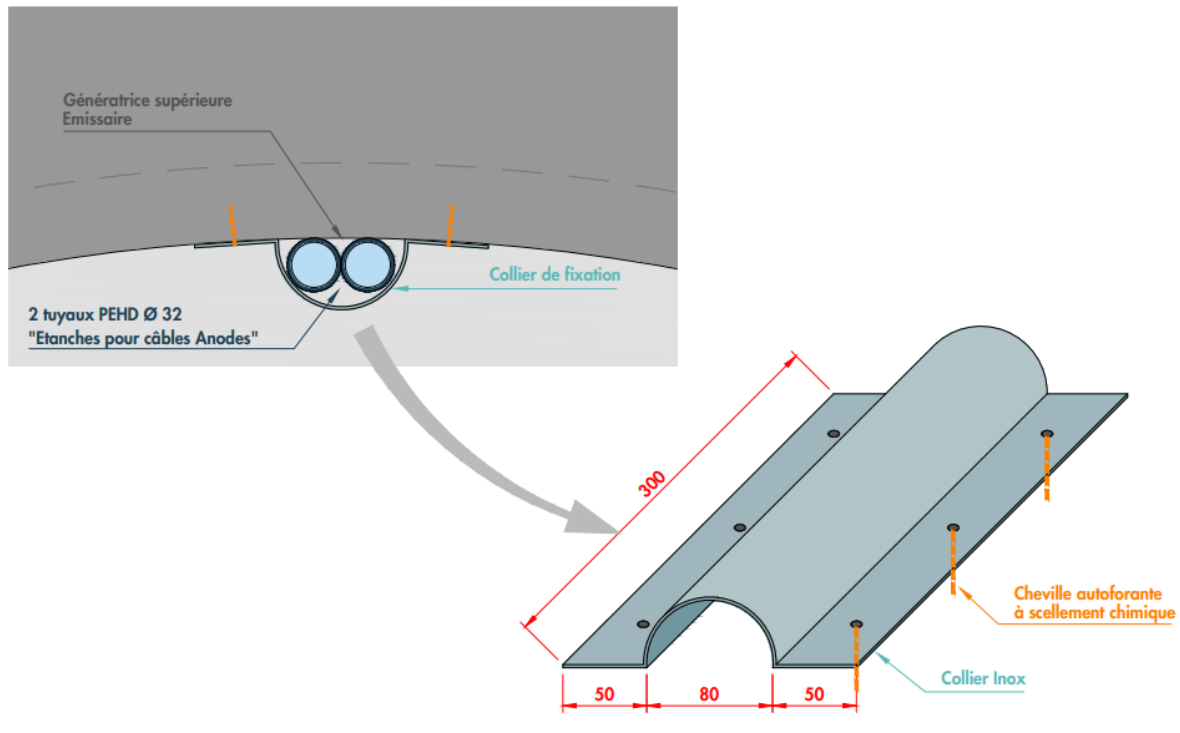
Détail de fixation des câbles à la conduite ((extrait plans annexe n°6))
